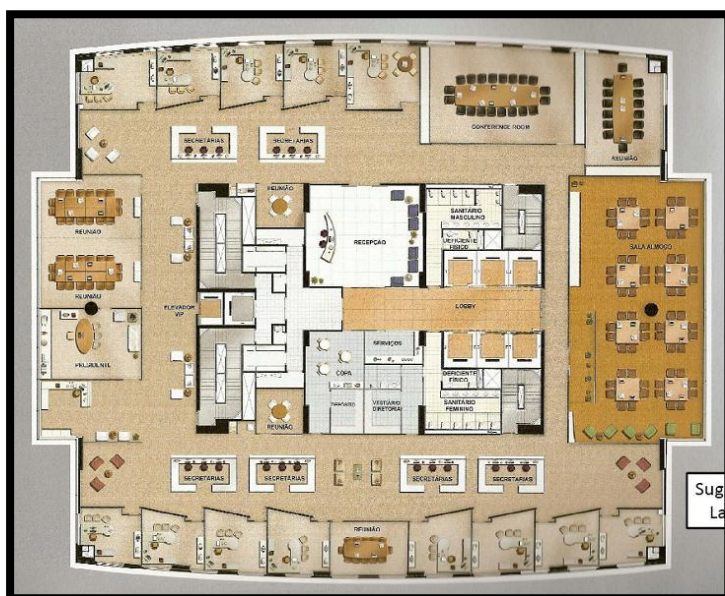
Leiaute do pavimento tipo do edifício Eldorado Tower. Fonte: Ferreira
